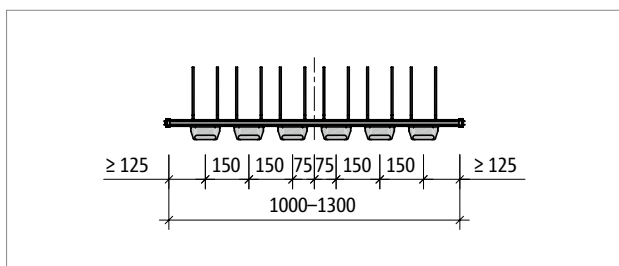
Schöck Tronsole® typ T-V4...-L1001 až L1300: Půdorys prvku
